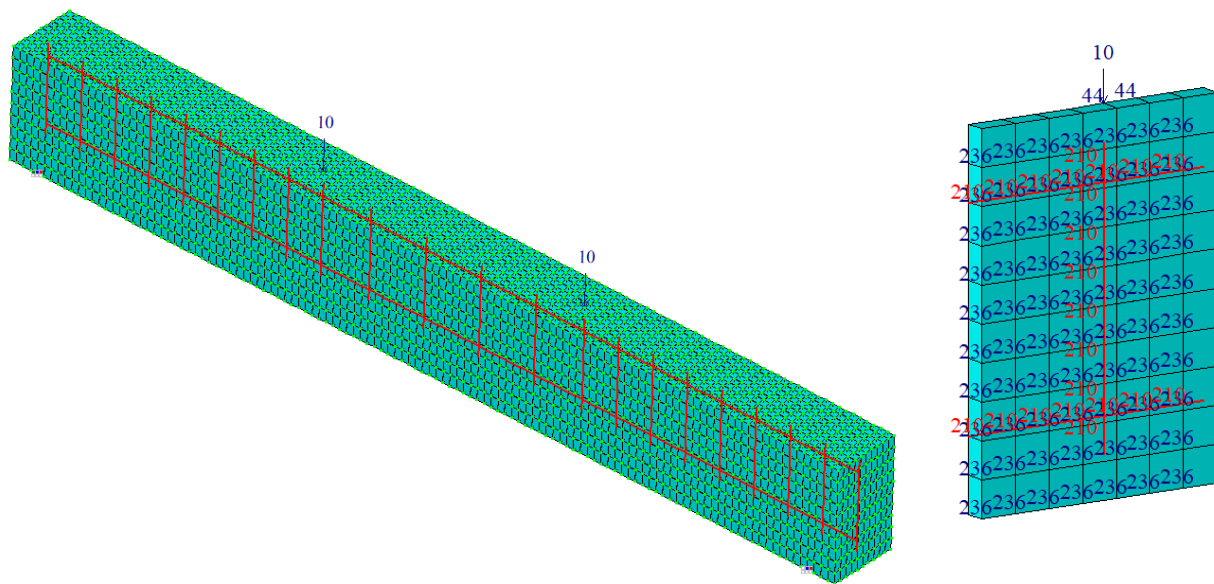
Объёмно–конечно элементарной модели модельной железобетонной балки
